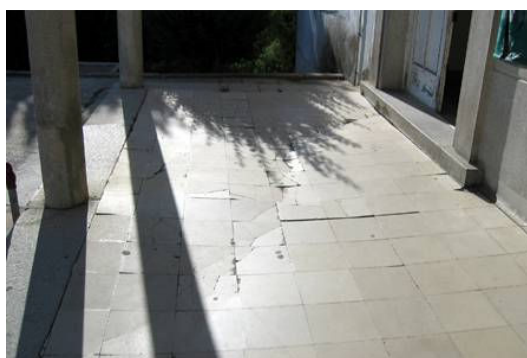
Assentamento (A29) de laje de alpendre exterior (Escola Secundária de S. Lourenço).
